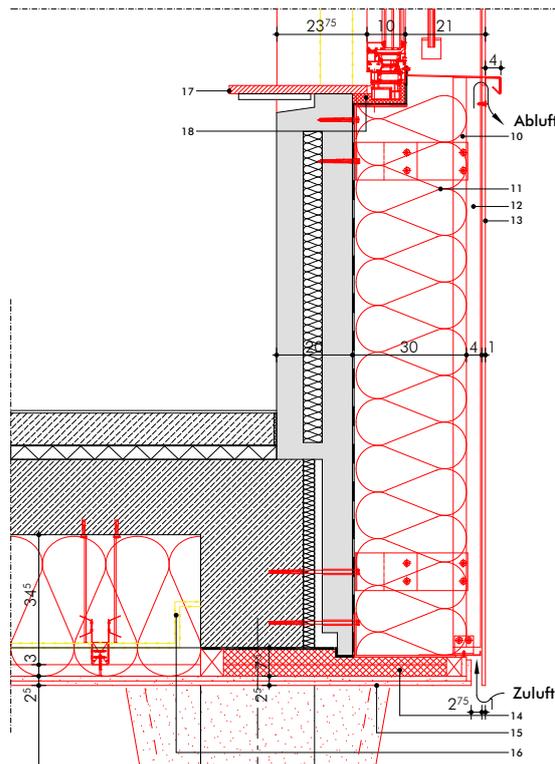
Fassadenschnitt Gymnasium Baesweiler
